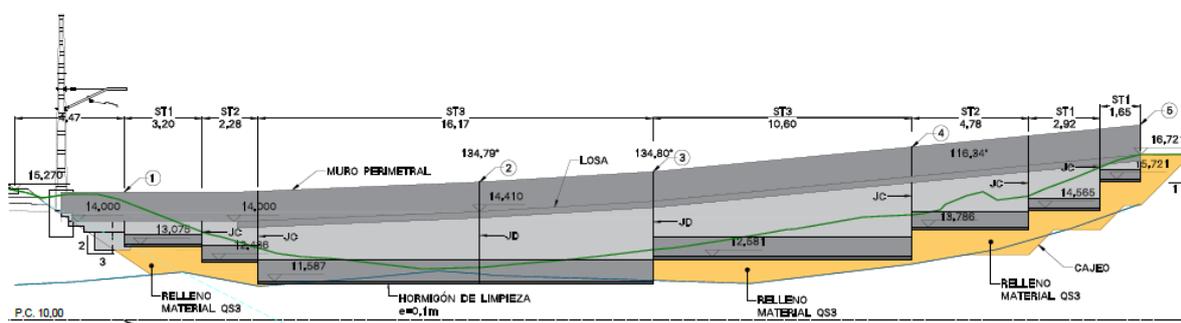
Muro de Hormigón armado próximo a vivienda existente.
